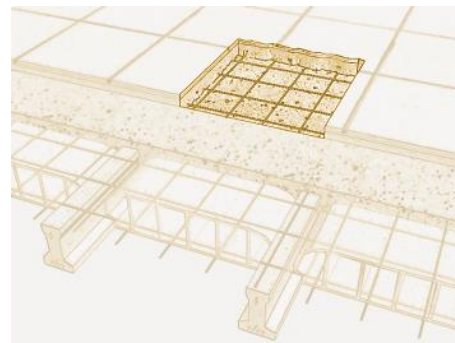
Cala realizada en losa maciza de concreto reforzado. (CYPE Ingenieros, 2019)
